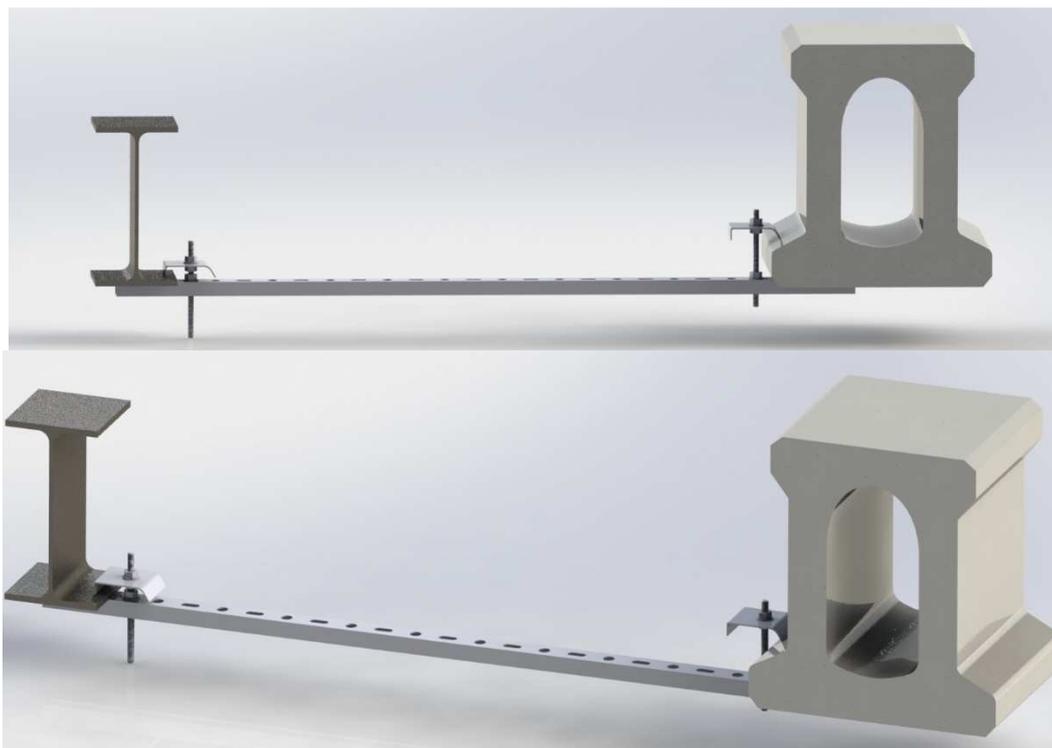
Sistema de sujeción sobre 2 perfiles de hormigón pretensado.
